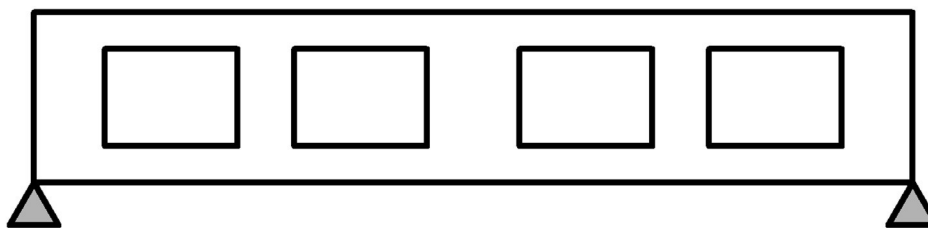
Duto de serviço transversal em vigas de concreto armado.
